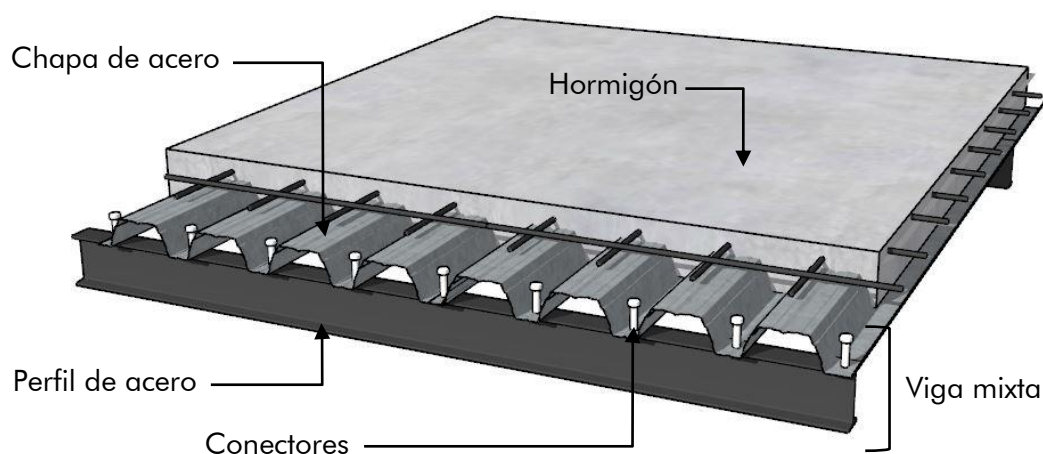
Viga mixta de acero – hormigón con conectores metálicos
